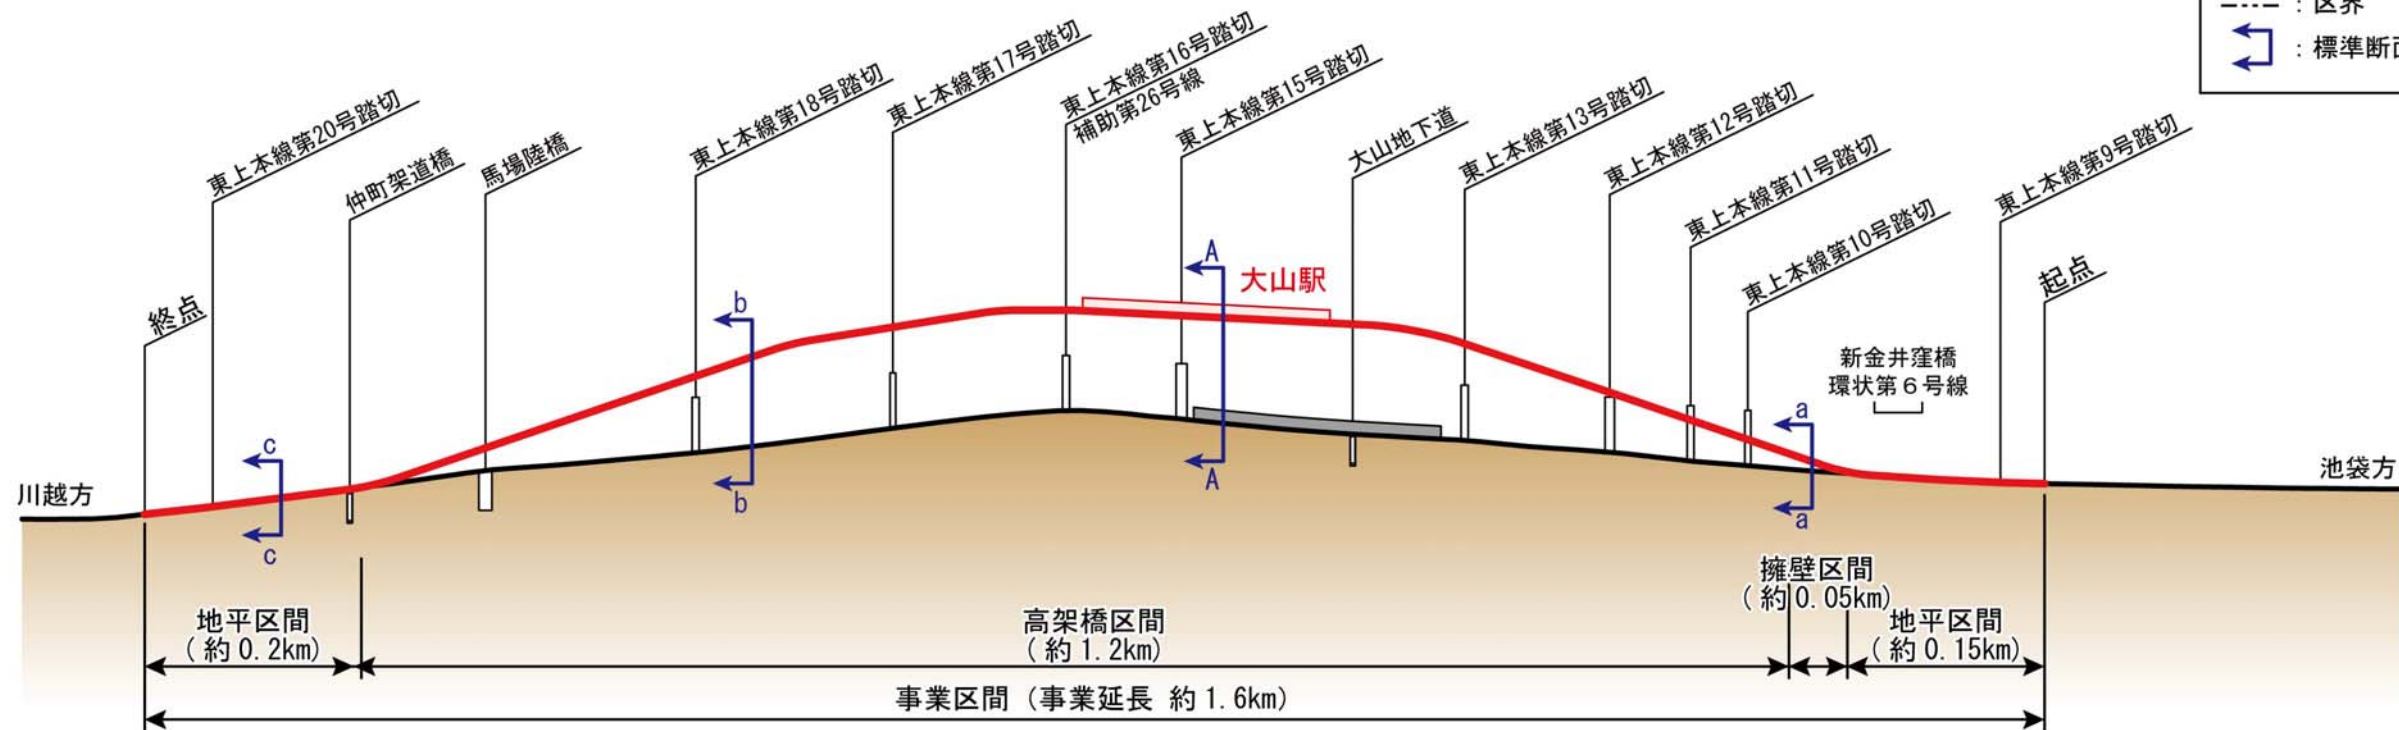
事業区間平面図及び縦断面図(東上本線)
